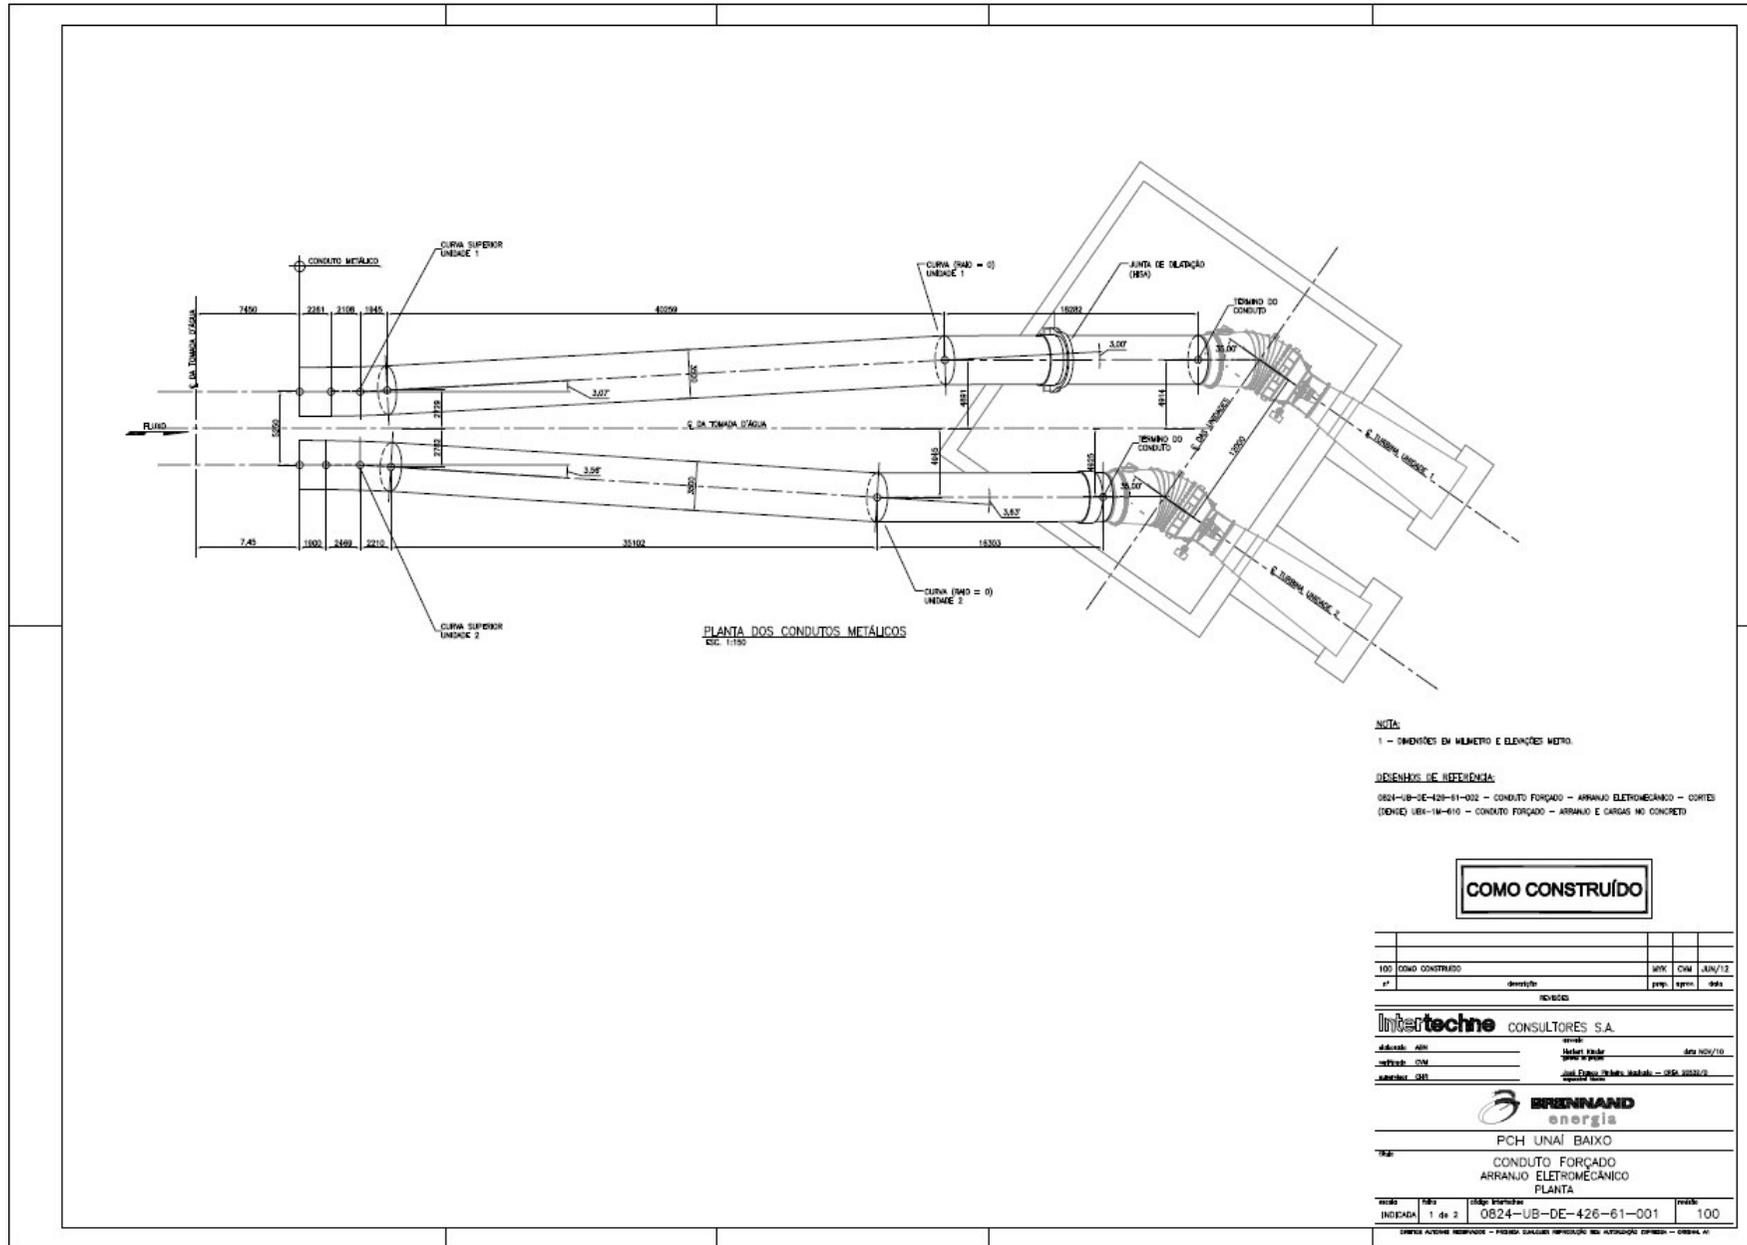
Planta geral dos contudo forçados desde a TA até a CF
